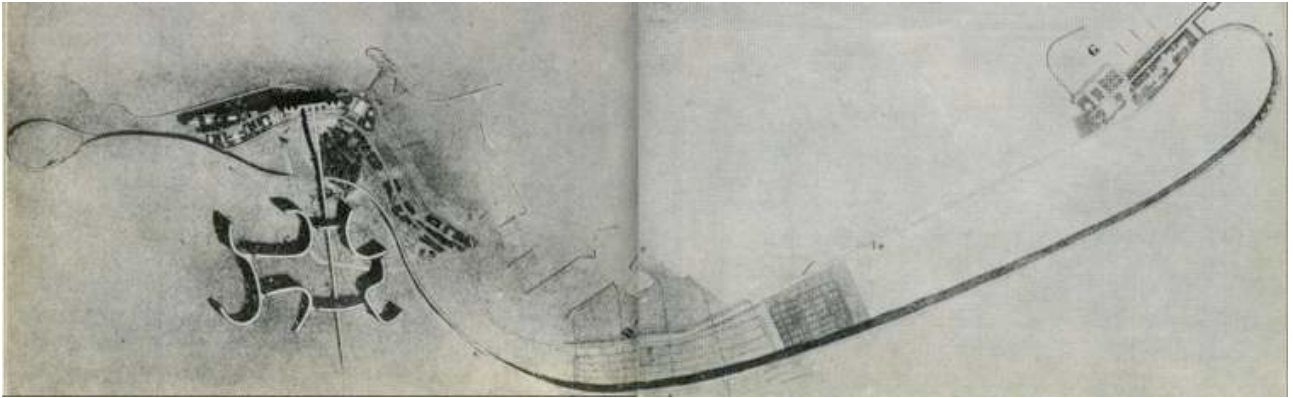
il Plan Obus per Algeri, planovolumetrico e prospettiva.
